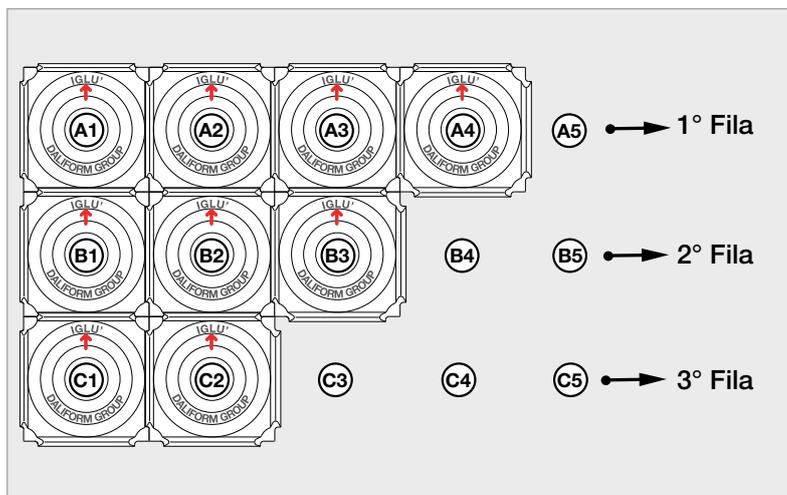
Sequenza di posa a secco degli elementi per righe.
